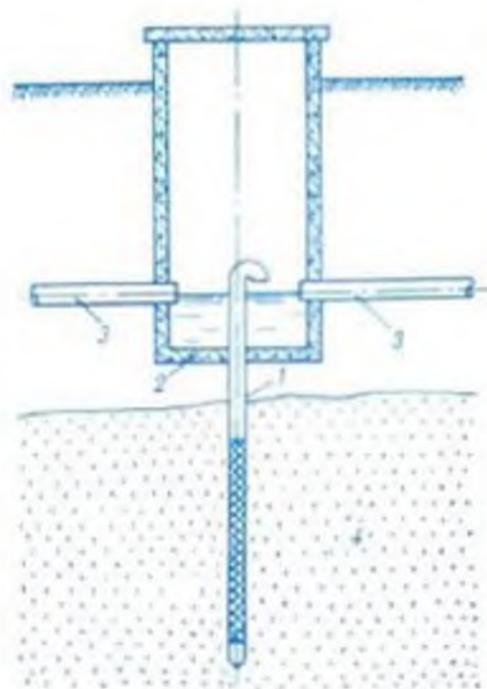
Комбинированный дренаж. Соединение вертикальной скважины с горизонтальным дренажем посредством дренажного смотрового колодца: 1 — самоизливающаяся скважина; 2 — железобетонный колодец; 3 — дренажные трубы; 4 — панорный пласт.
